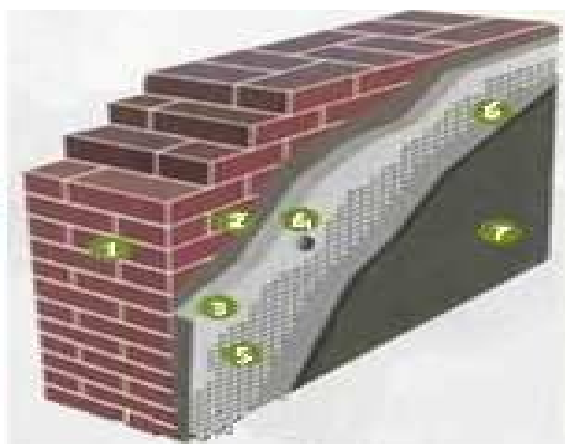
Наружное утепление кирпичной стены пенополистиролом
